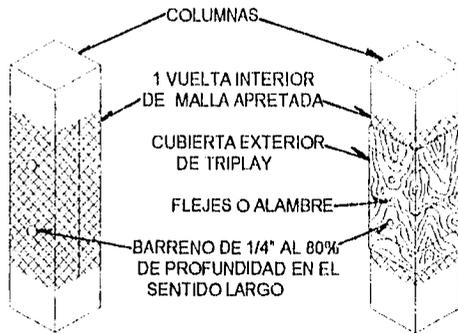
III BARRENADO Y PROTECCIÓN EN COLUMNAS DE CONCRETO.
